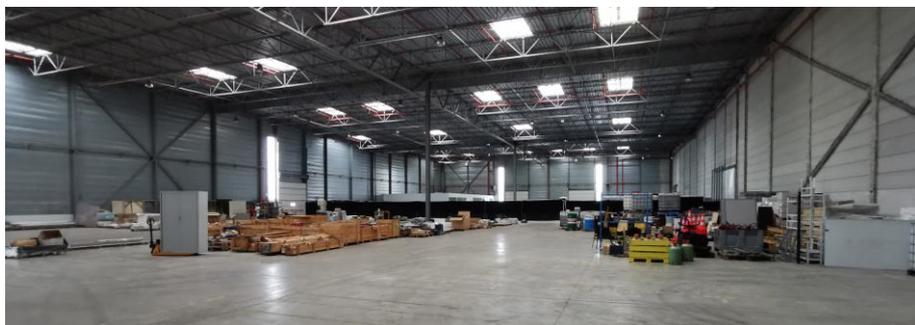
Vue du Hall 3 (dédié à du stockage divers)
